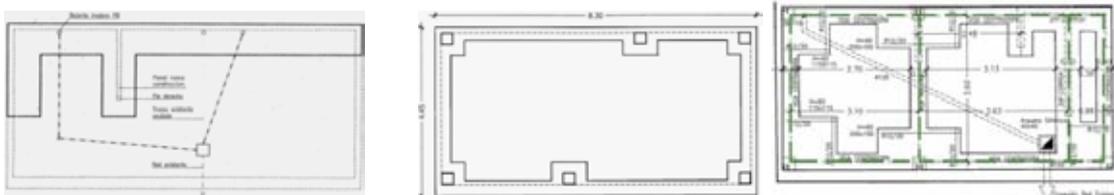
Recalce de cimientos y replanteo de fundación corrida en estado inicial y propuesta.
